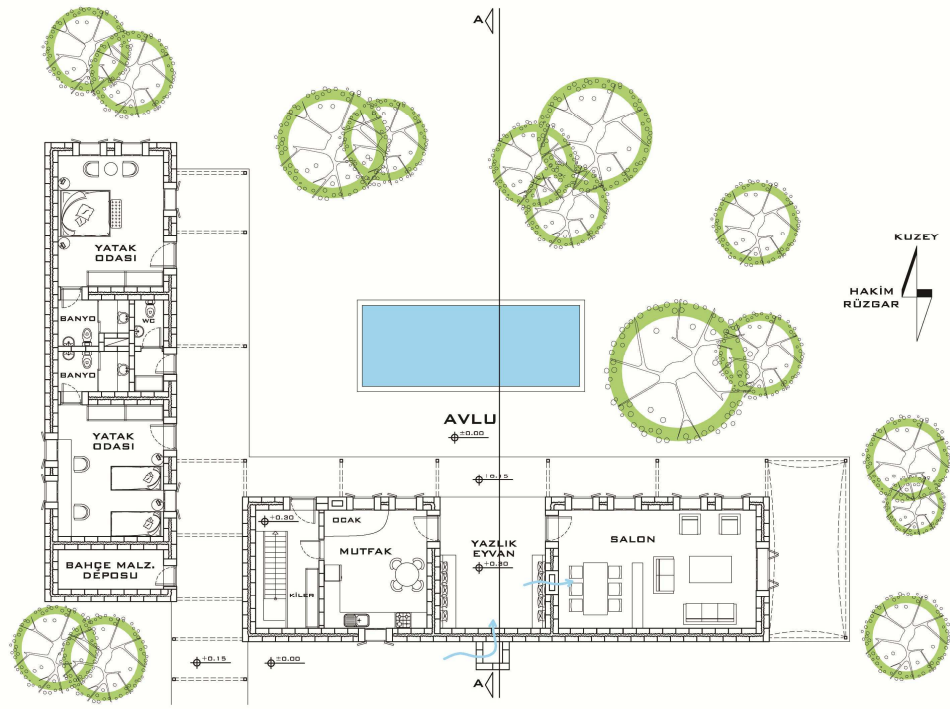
Tip 2; 2-4 kişilik aile konutunun vaziyet planı
